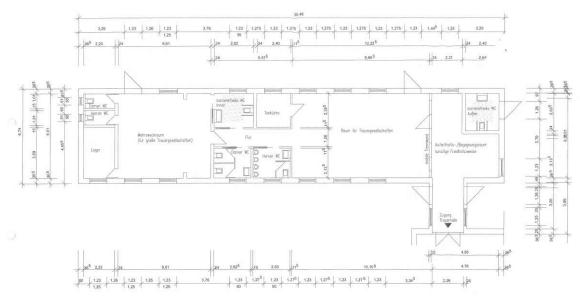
Grundriss Planung Trauerhalle. Ohne Maßstab
